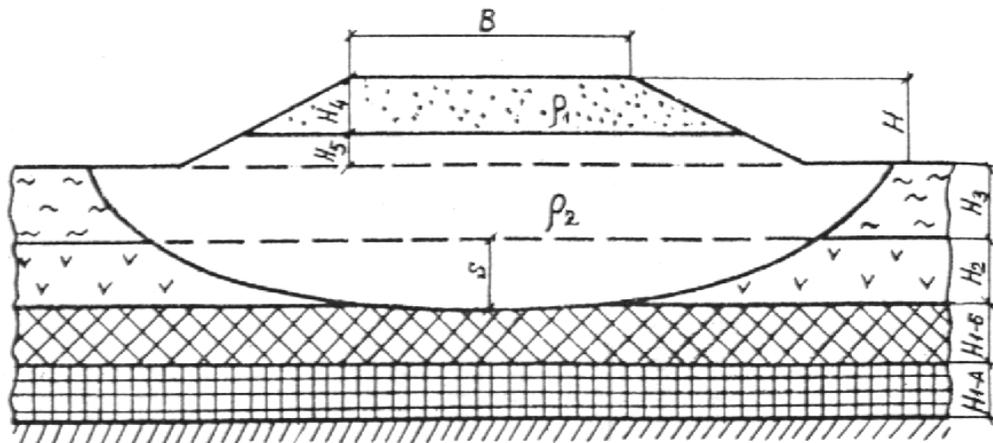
Расчетная схема для определения величин конечных осадок насыпей на болотах
